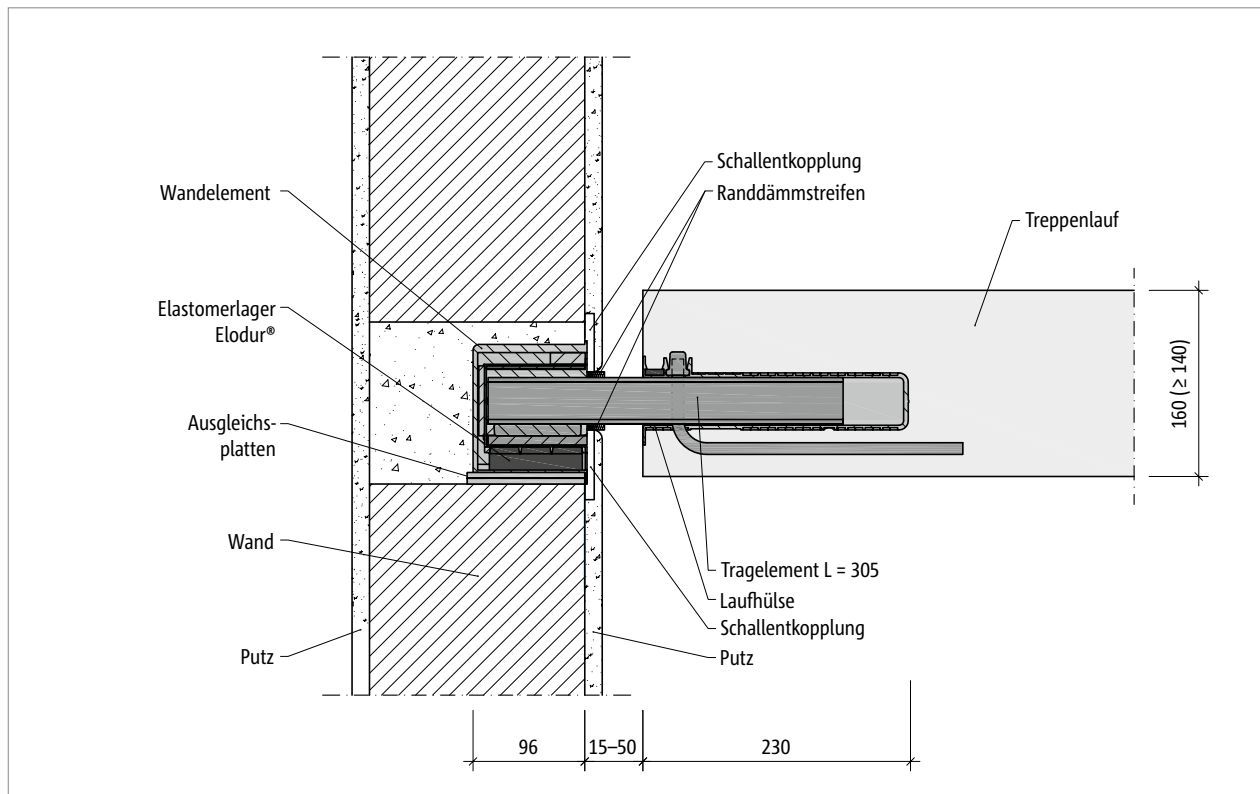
Schöck Tronsole® Typ Q-FV oder Q-A2: Einbauschnitt mit Elementtreppenlauf
